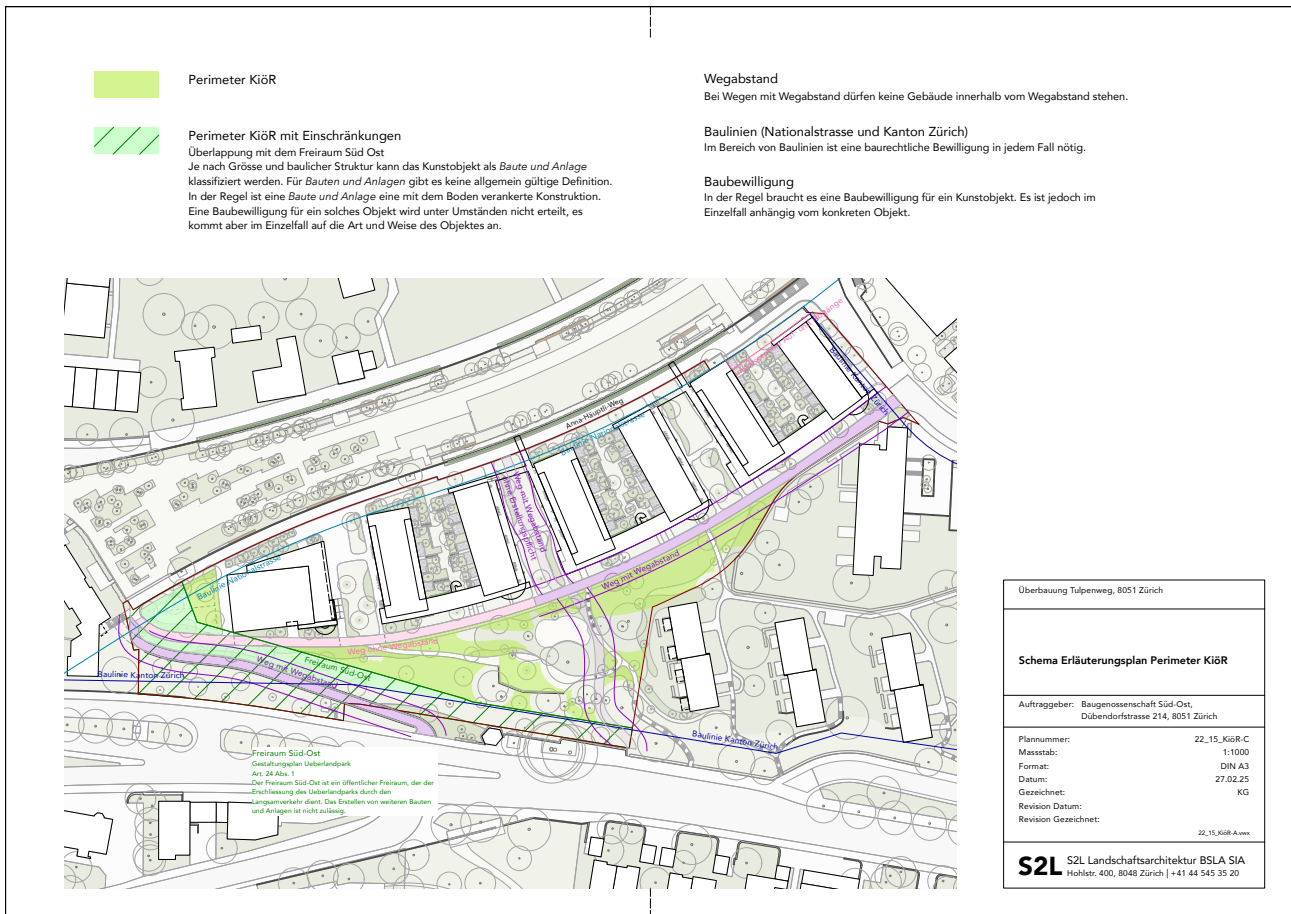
Situationsplan Umgebung / Perimeterplan KiöR
